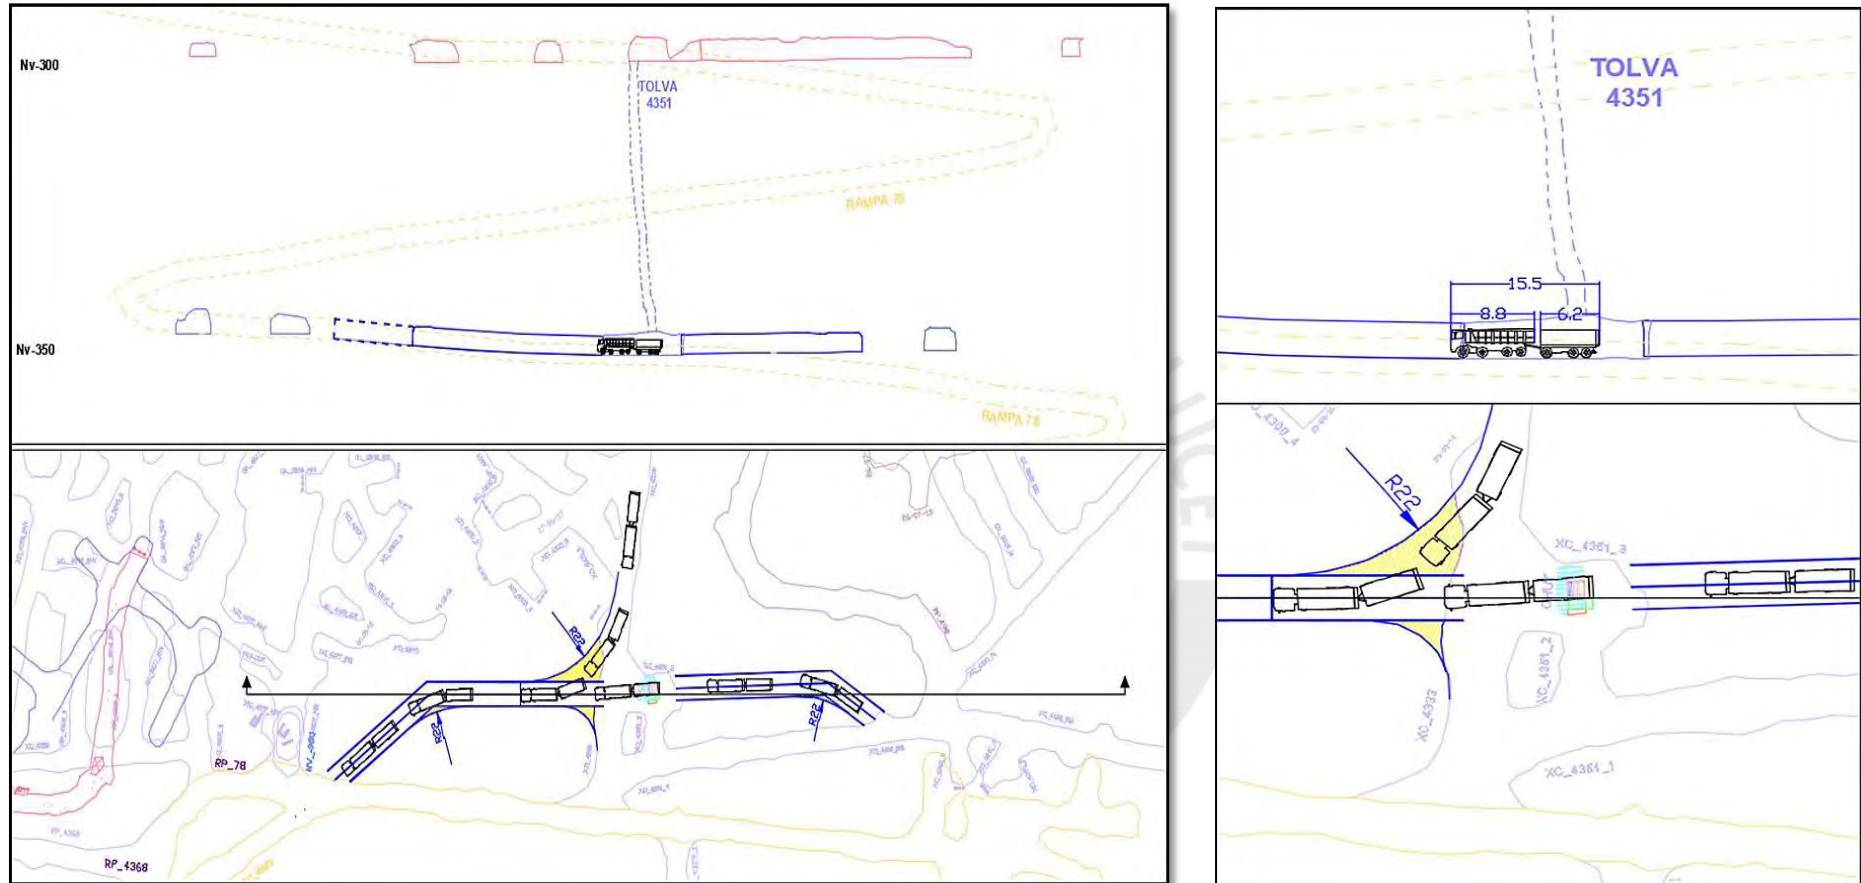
Proyecto: Crucero para volquete de doble tolva, vista en planta Nivel 350
